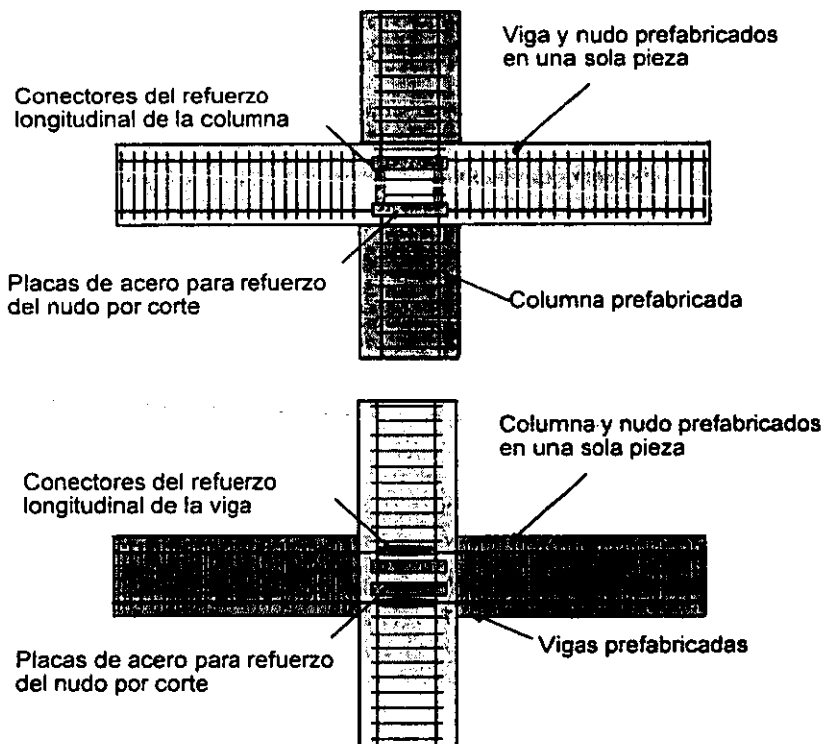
Conexiones viga–columna ensayadas en Japón
